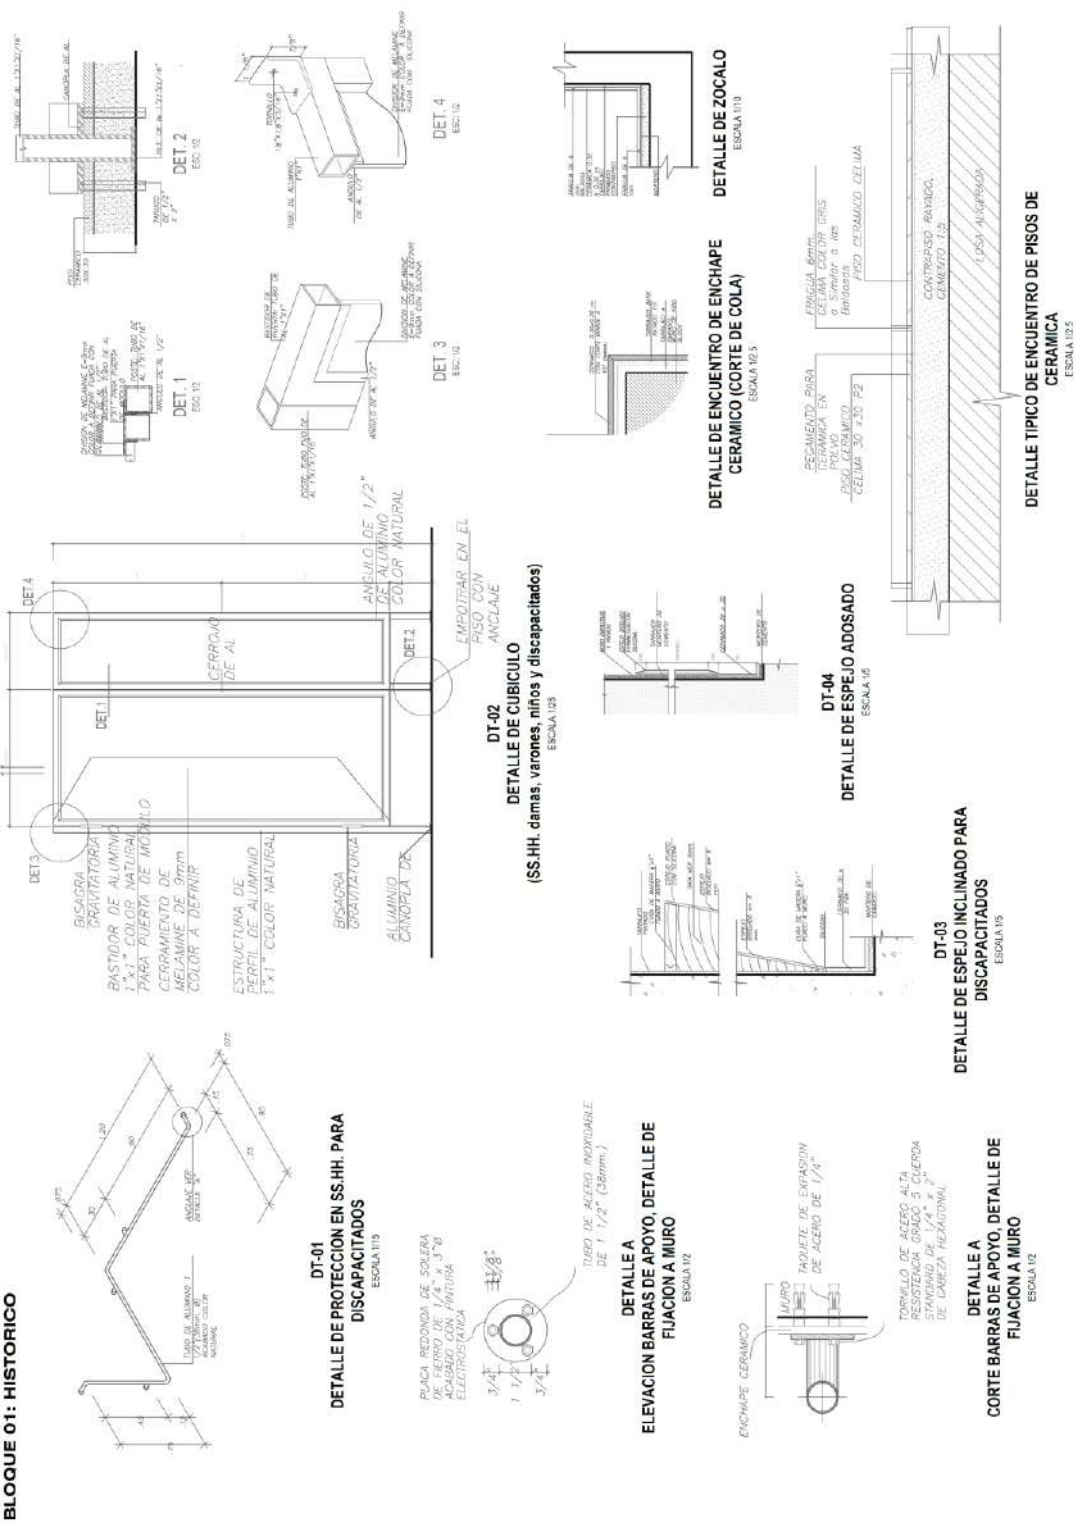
Detalles constructivos de servicios higiénicos - Sector 1.
